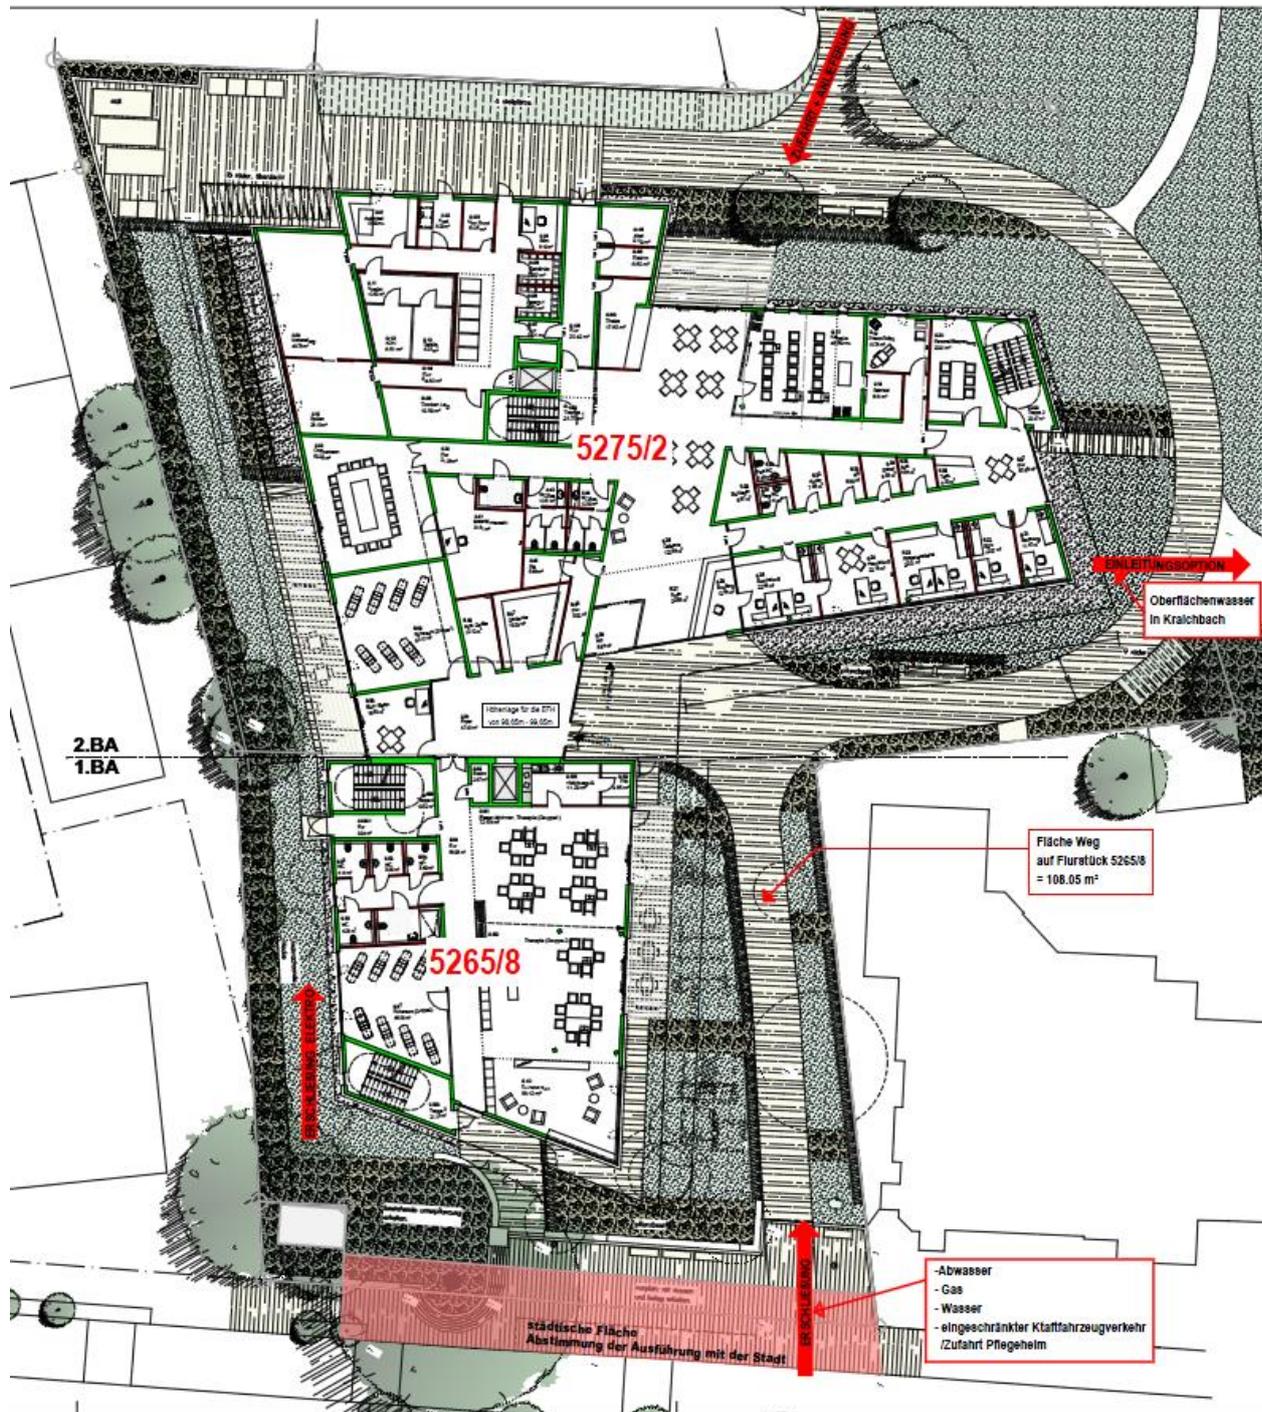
Bauabschnitt 1 & 2 (EG Grundriss und Freiflächen)
